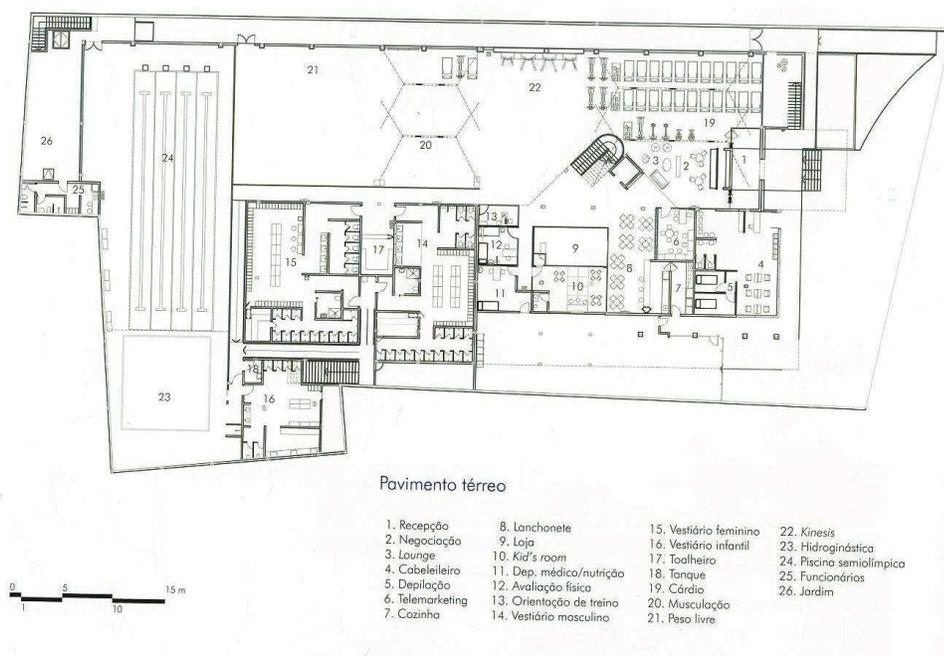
Planta Baixa do Pavimento Térreo da Péle Club. Fonte: Cris Correa, 2011. p. 62
